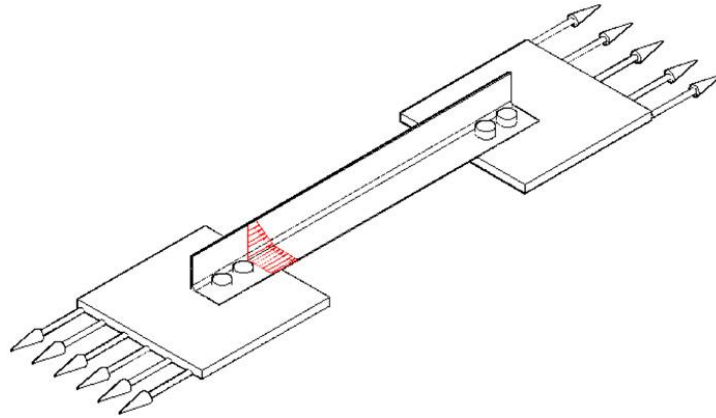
Fenômeno *shear lag* em cantoneiras submetidas à tração (PRABHA et al., 2011).
